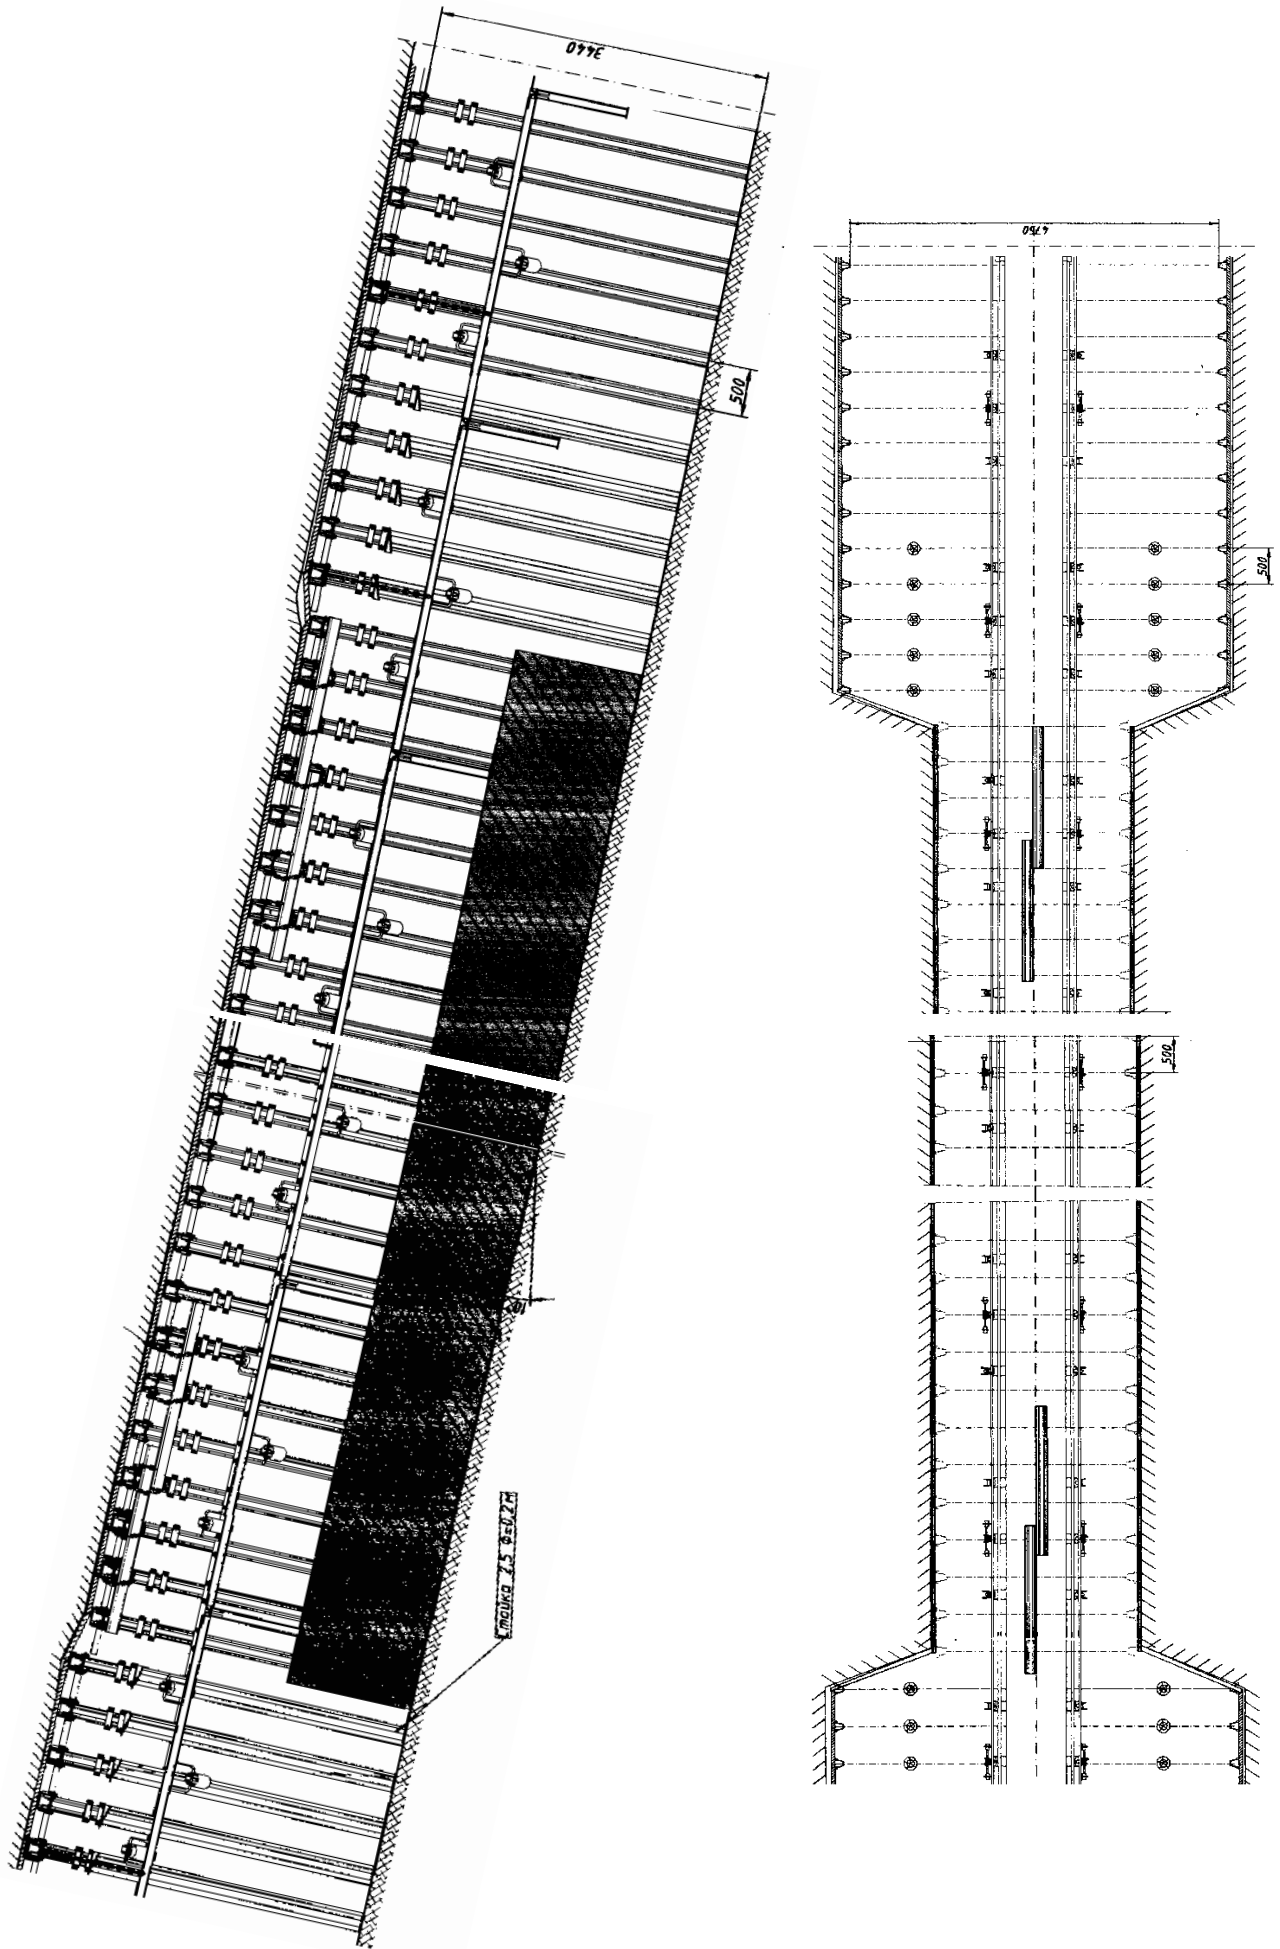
Поздовжній переріз ухилу на ділянці перекріплення
